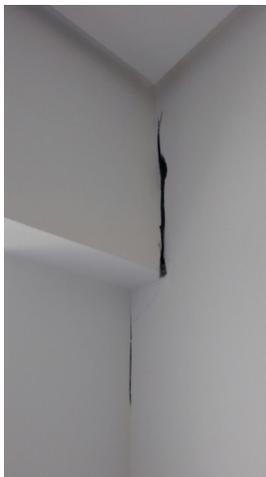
Material isolante da instalação de ar condicionado estrangulada
